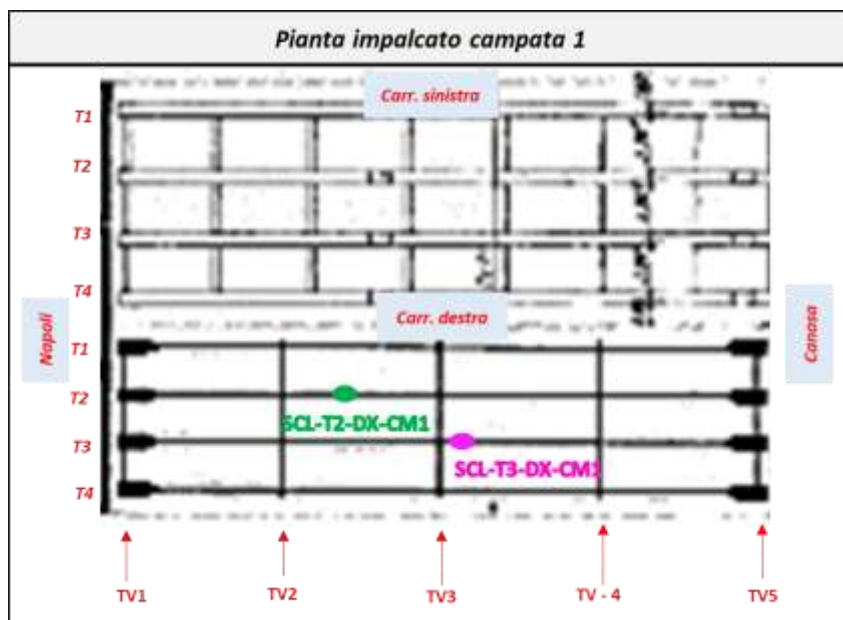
Ubicazione prove in pianta e documentazione fotografica – Prove sclerometriche
